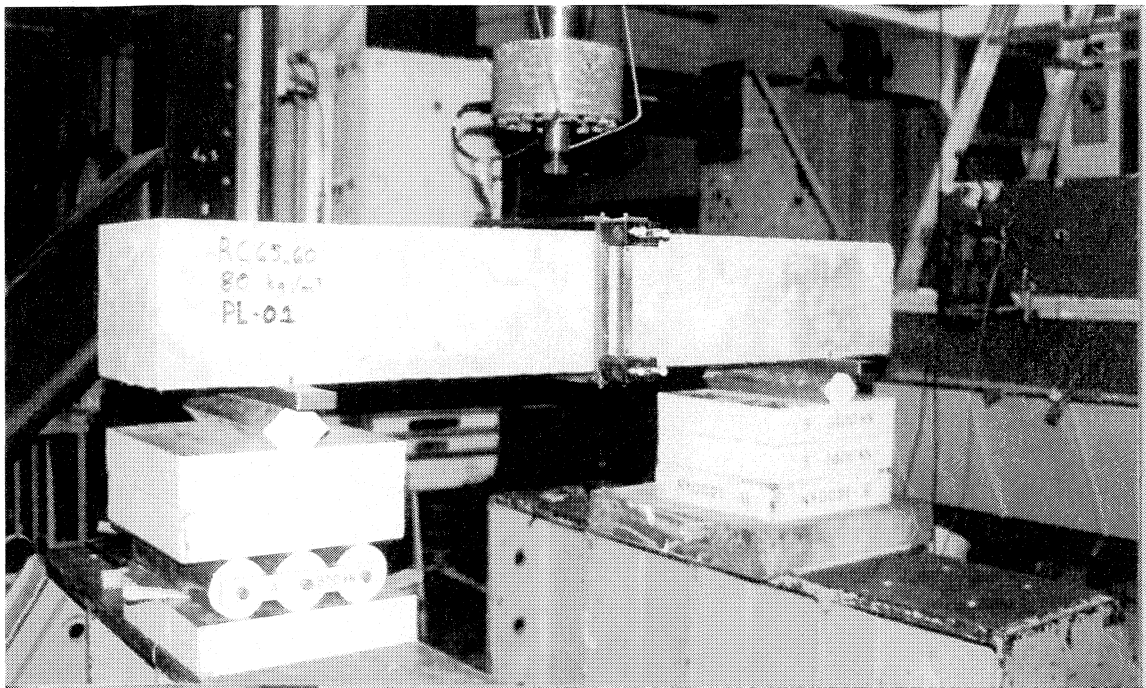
Montage expérimental d'un essai de flexion sur poutre DBM avant l'installation des LVDT
